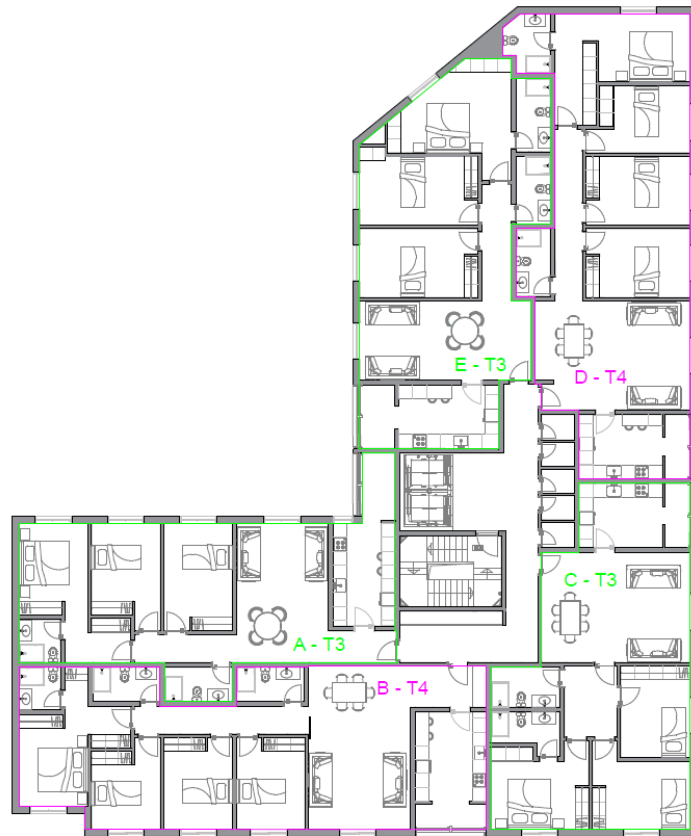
Planta dos pisos 1,2 e 3 dividida por frações
